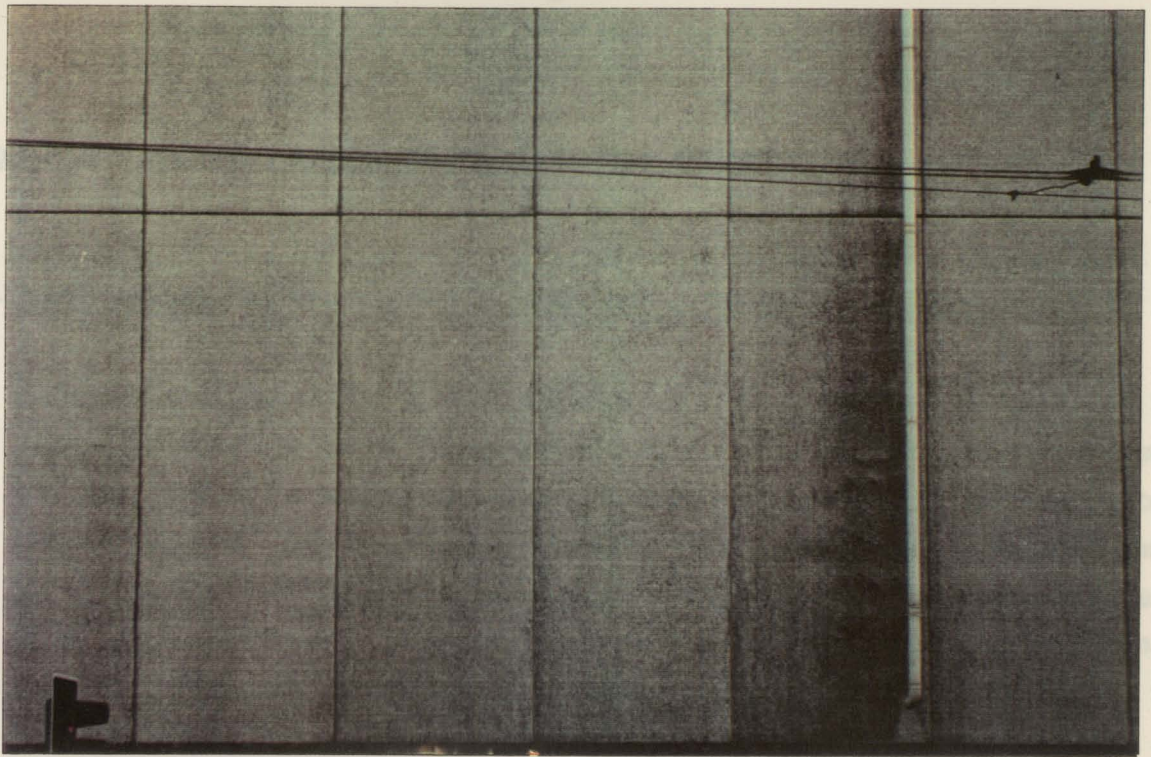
Superfície de inertes à vista tendo sido utilizado o método de retardador de presa
